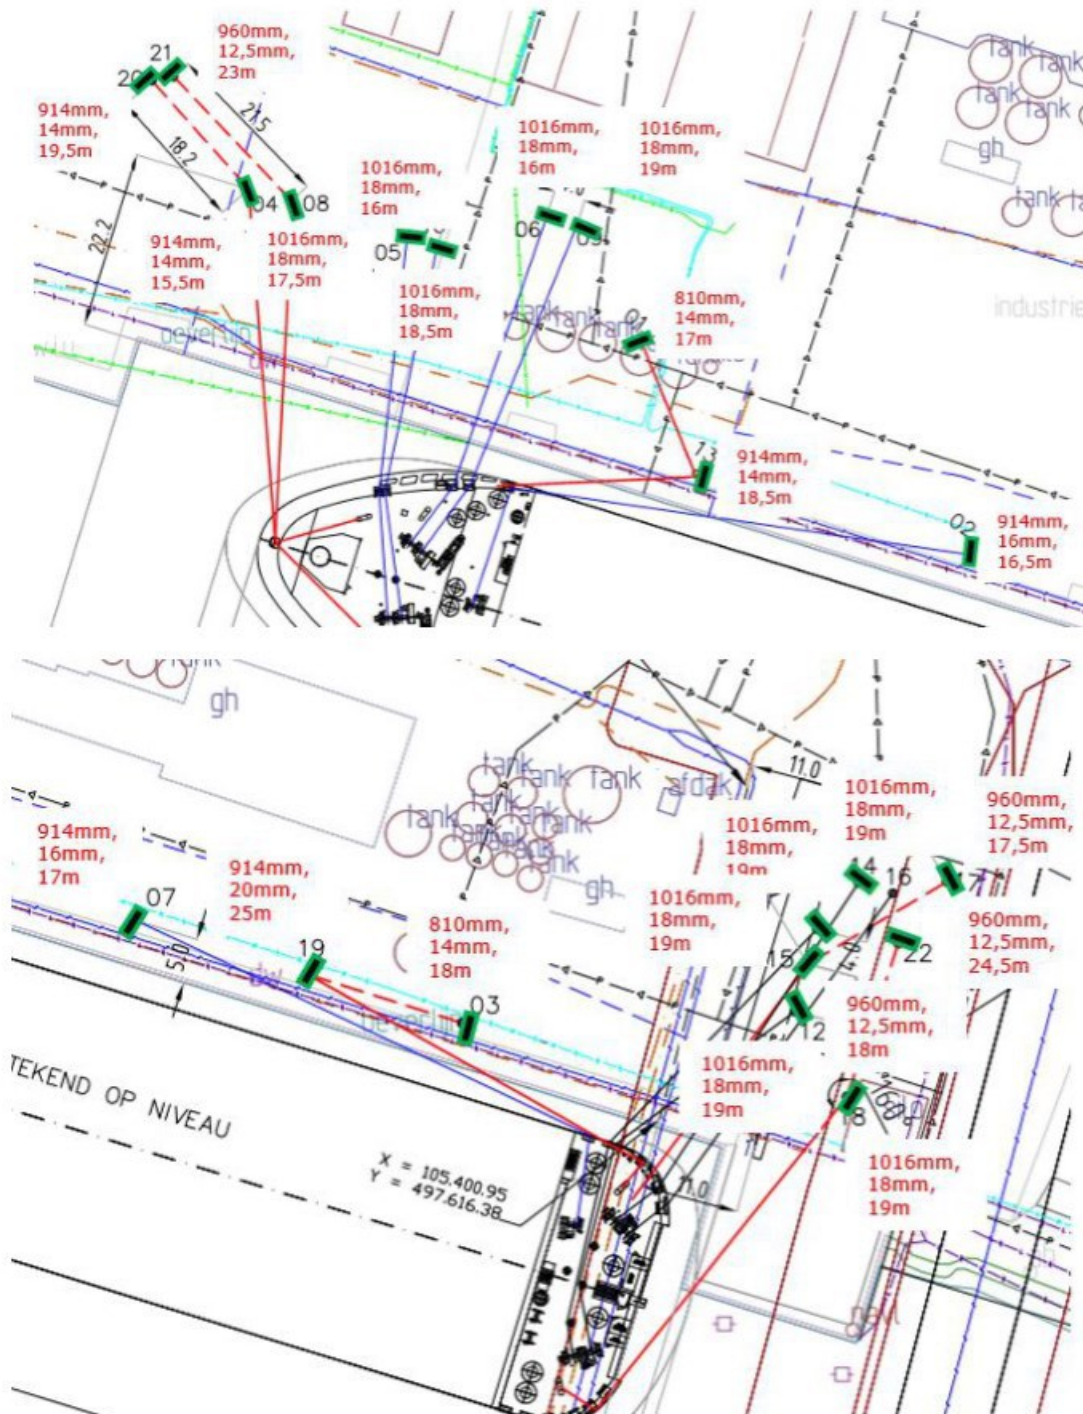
Beschikbare ruimte tussen buispaal en bestaande ankerstangen
